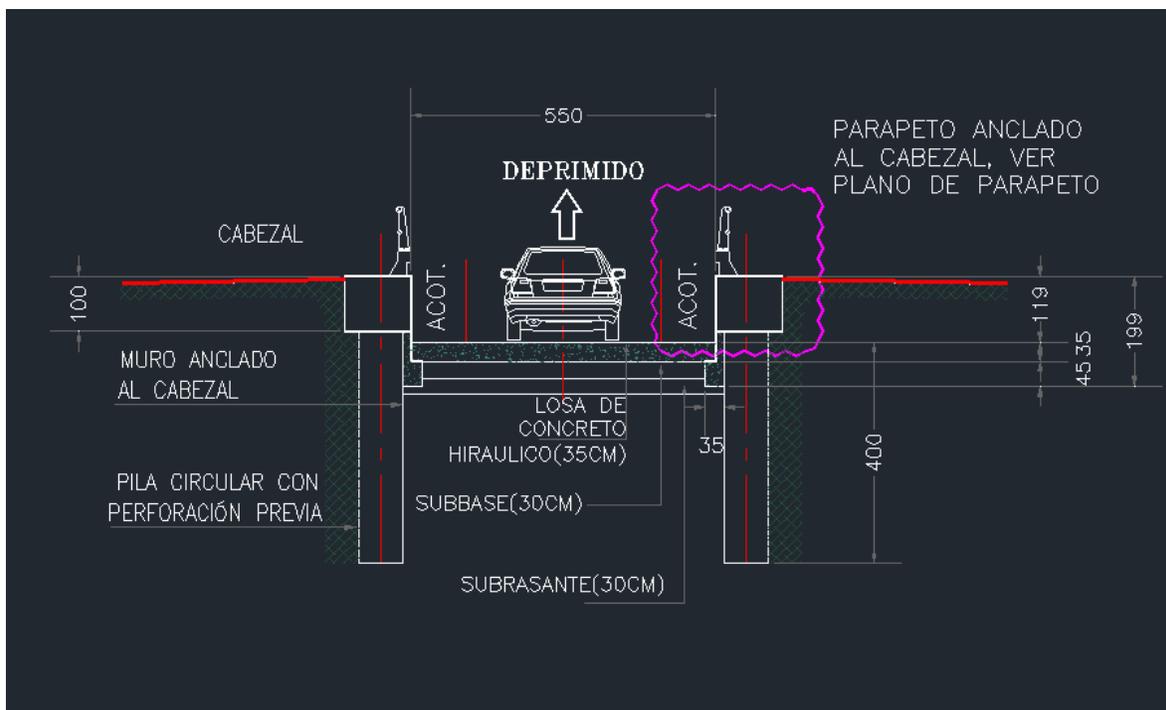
Sección transversal 0+000 del inicio del deprimido (incorporación Nextipac).
